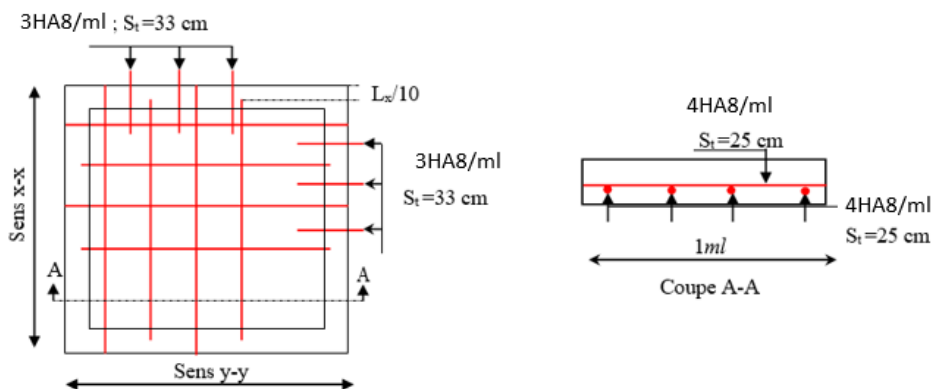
Schéma de ferrailage de la dalle du local machine.
